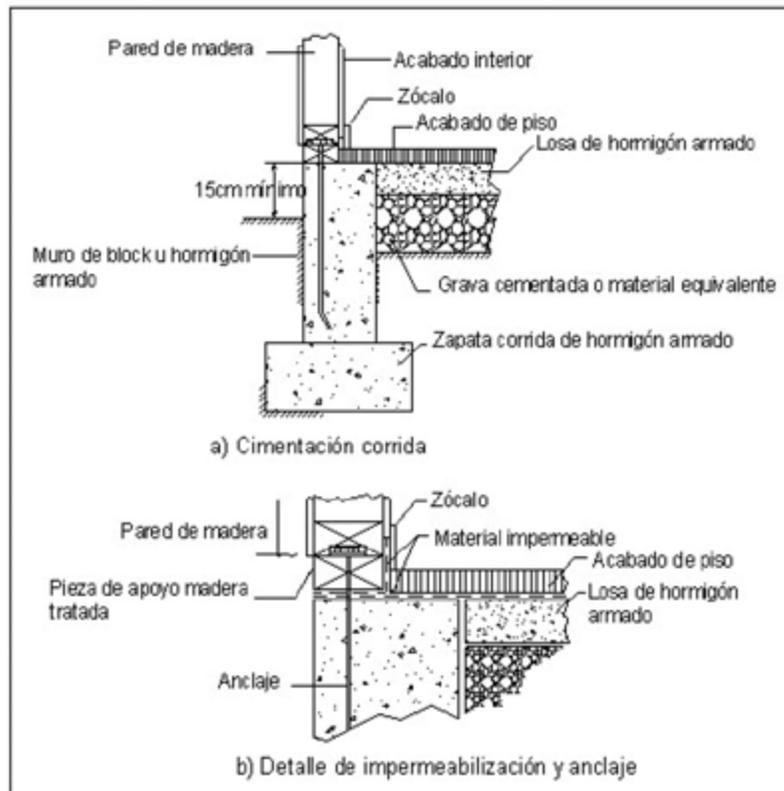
AISLAMIENTO DE LA HUMEDAD EN PISOS Y ENTREPISOS SOBRE MUROS (CIMENTACIÓN CORRIDA)
